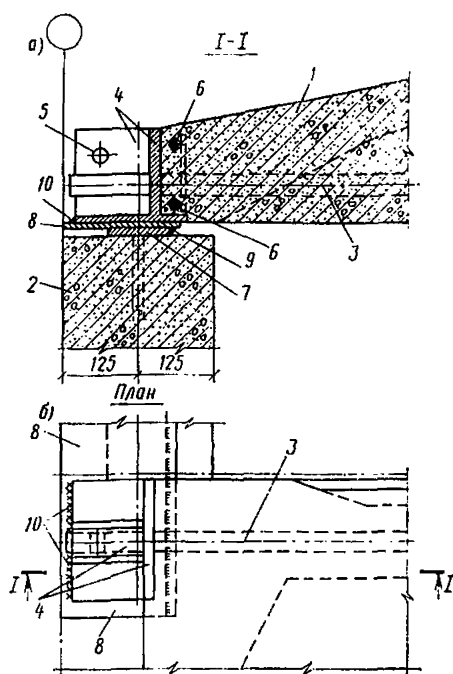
Узел опирания панели-оболочки КЖС на продольную балку
